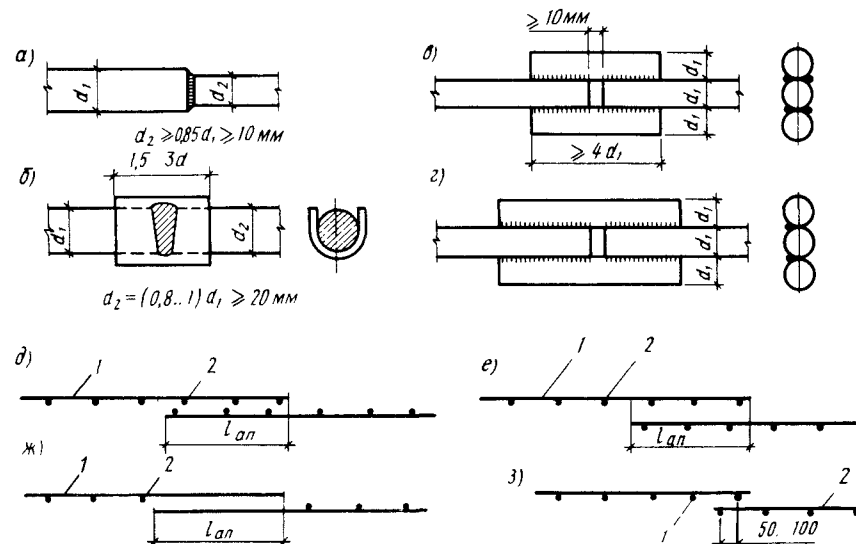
Сварные стыки ненапрягаемой арматуры и стыки сеток
